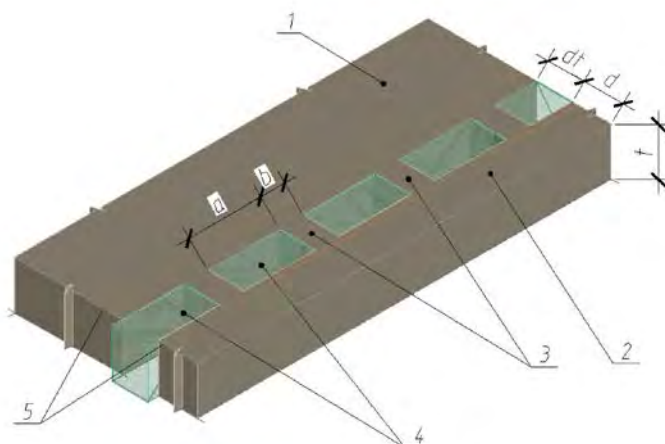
Схема расположения торца диска перекрытия с перфорацией: 1 — перекрытие; 2 — торцевой брус; 3 — шпонки; 4 — перфорация, заполненная утеплителем; 5 — зона утеплителя стены
